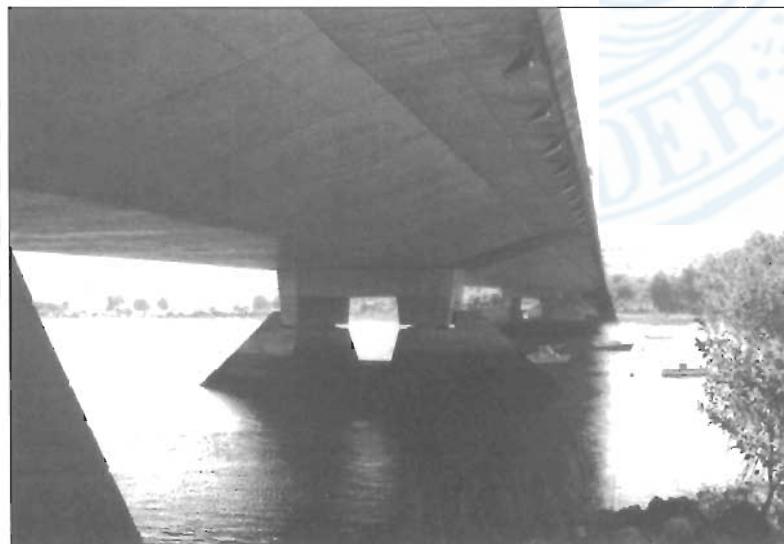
Viaducto de la A-8. Detalle de pilones y tablero.
